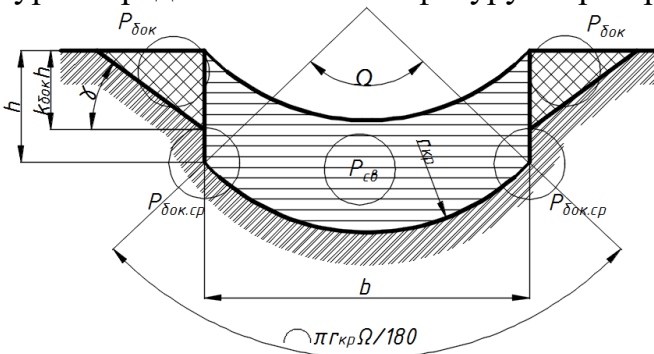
Схема действия сил резания ножевым ИО с выпуклой формой режущей кромки ножа
